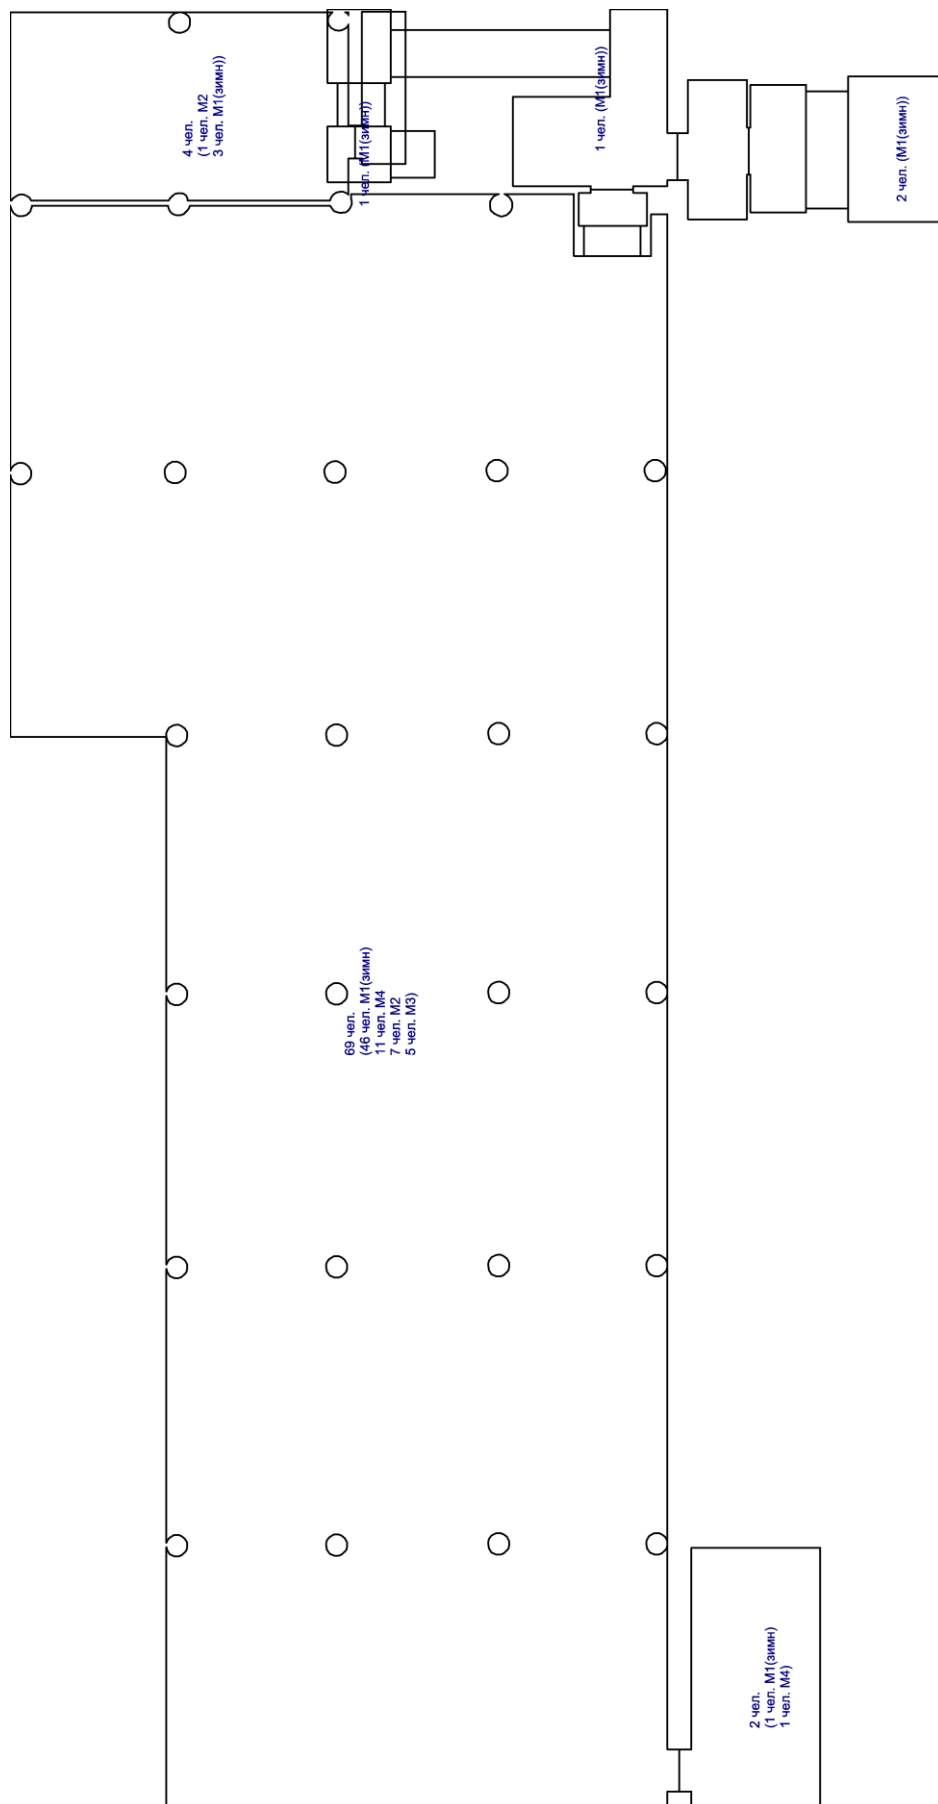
Размещение людей на плане этажаЭтаж 0,0 m
